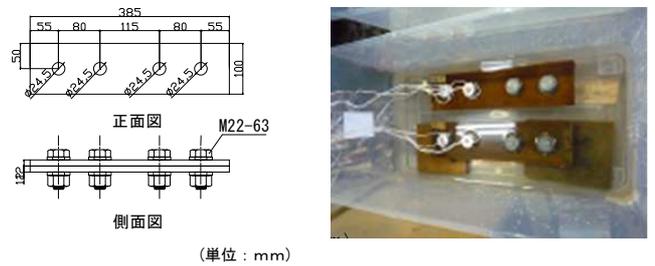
供試体の形状 写真-1 ボルト軸力計測状況
